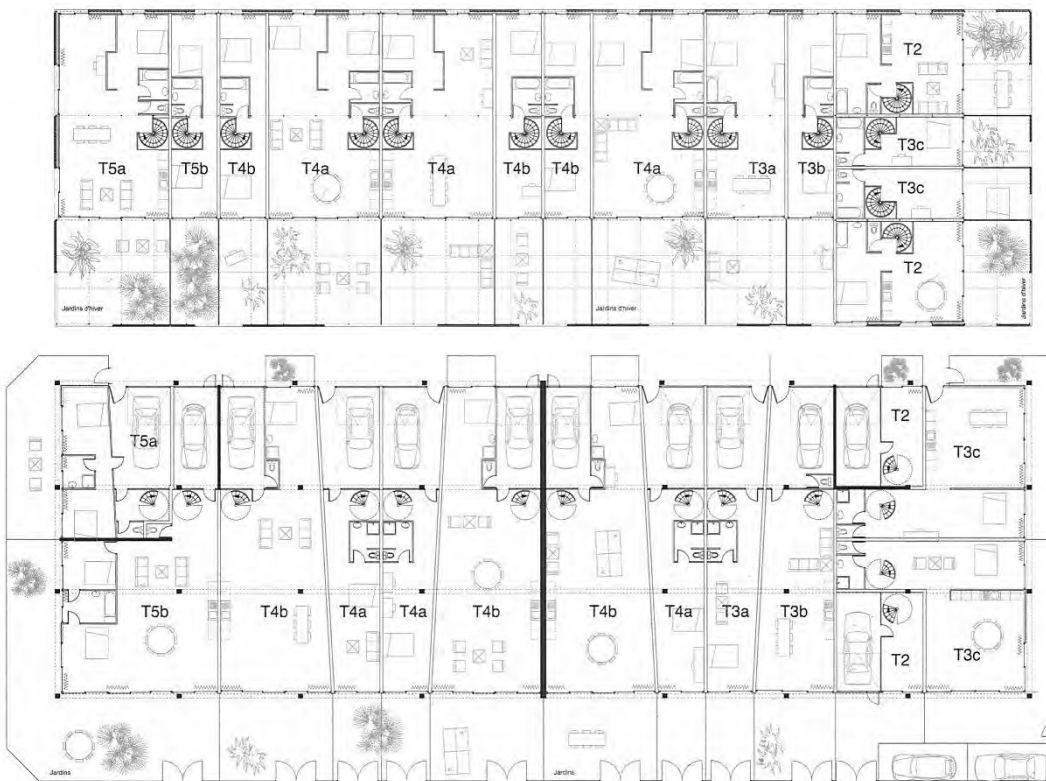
De arriba abajo, planta primera y planta baja de las viviendas sociales en Mulhouse, 2001-2005
